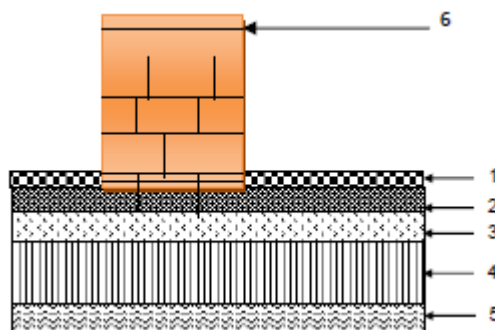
Coupe verticale du plancher d'étage courant [22].
